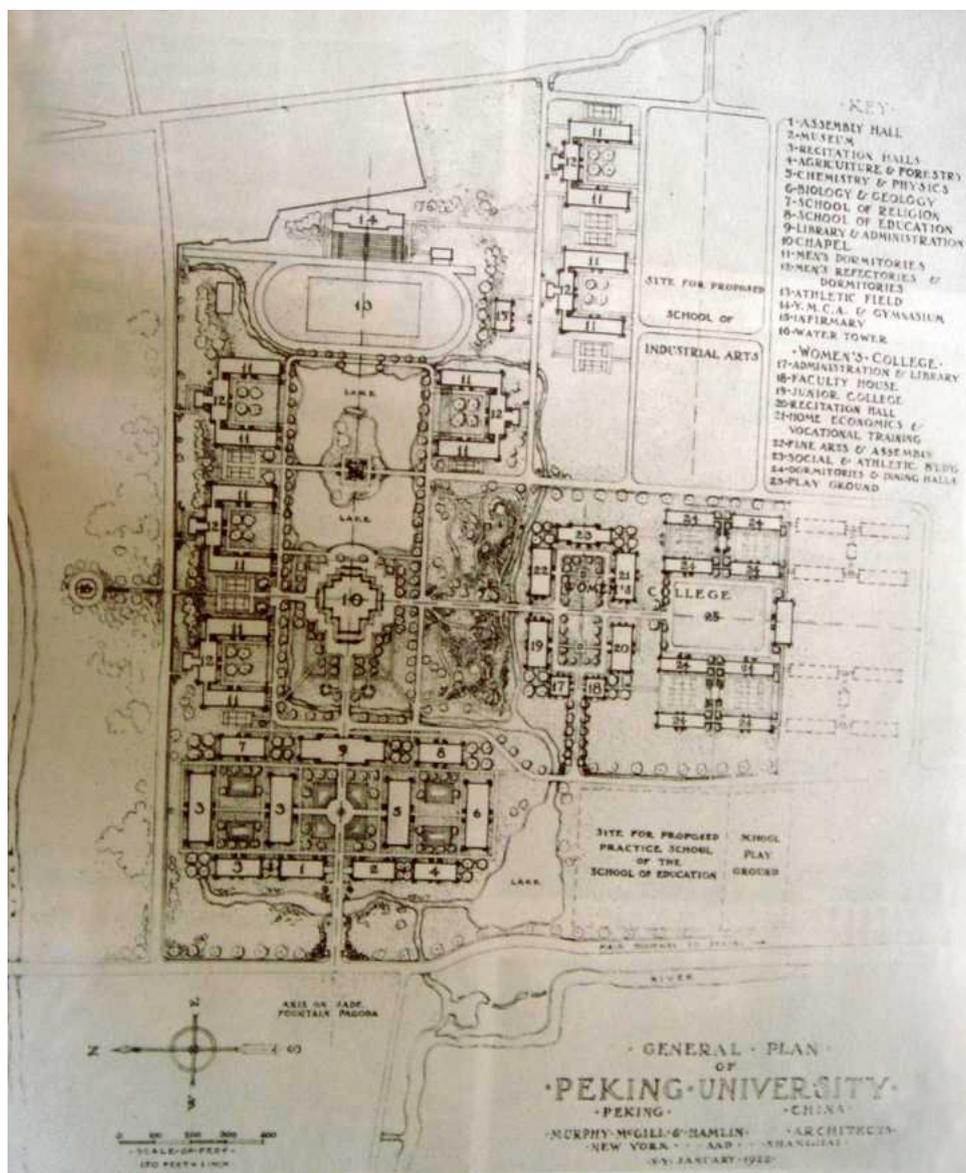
Plan general del complejo de la “Universidad de Yenching”
